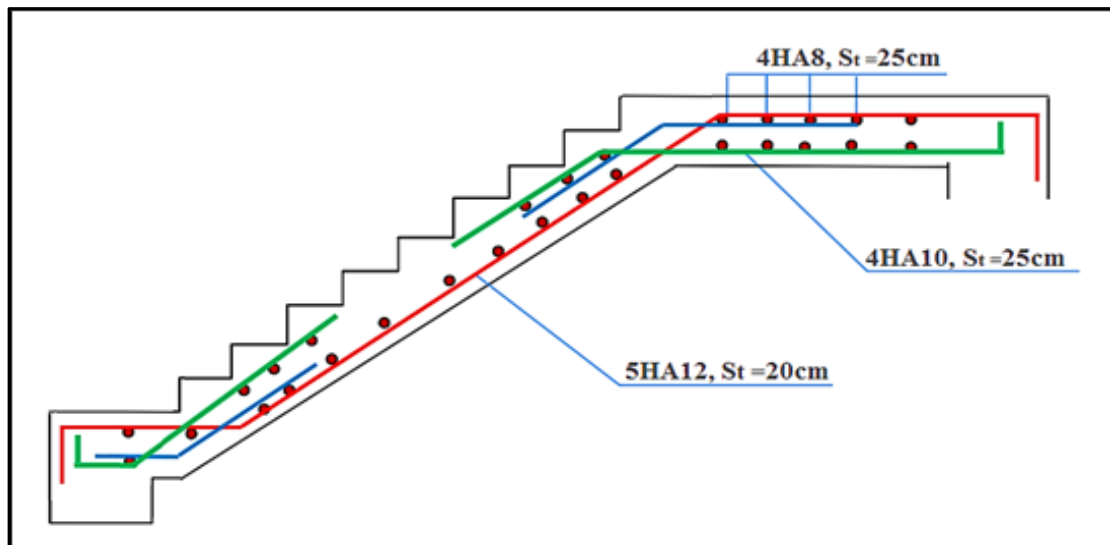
Schéma de Ferrailage d'escalier.
